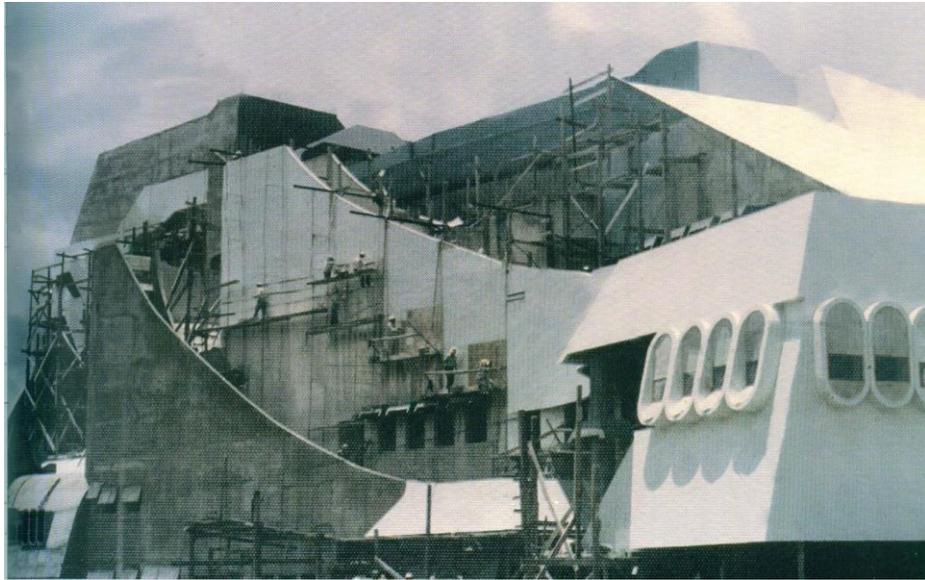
Construcción de la Fase 2 de la Fachada Este del CCMAA
